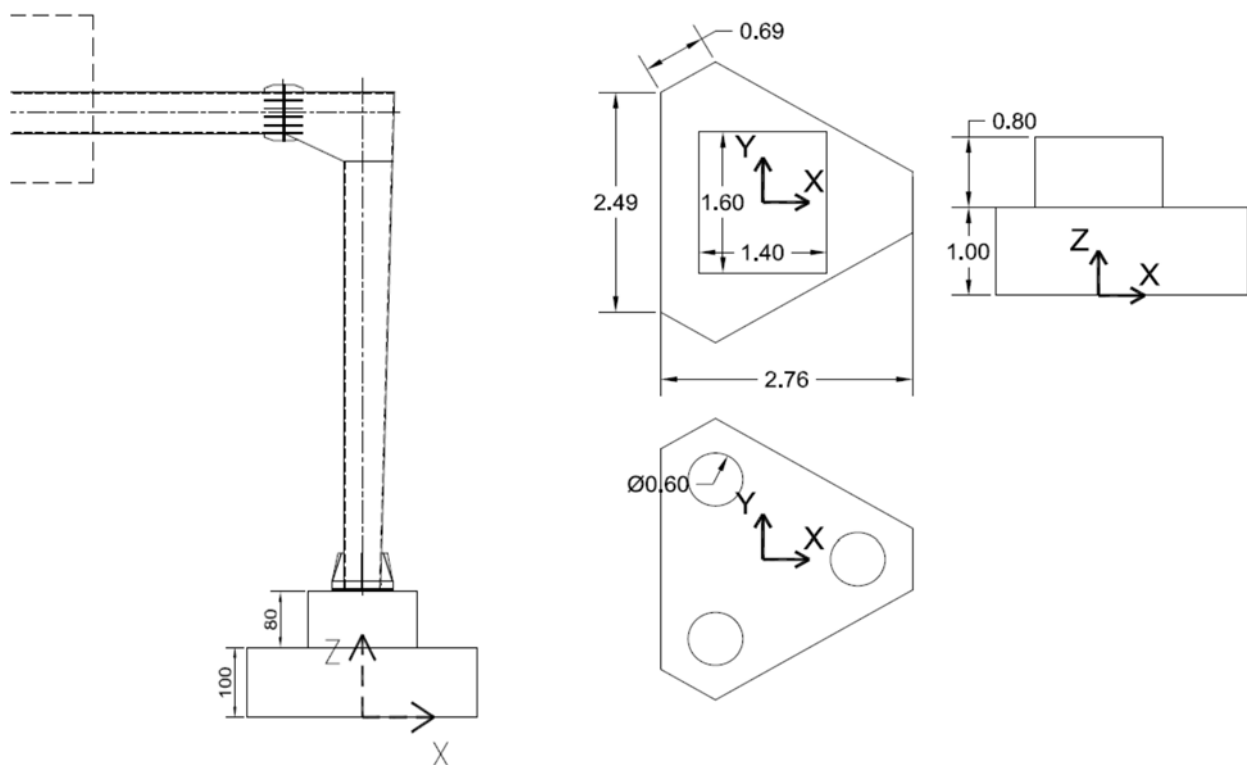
Carpenteria del plinto di fondazione - Posa su terreno pianeggiante
